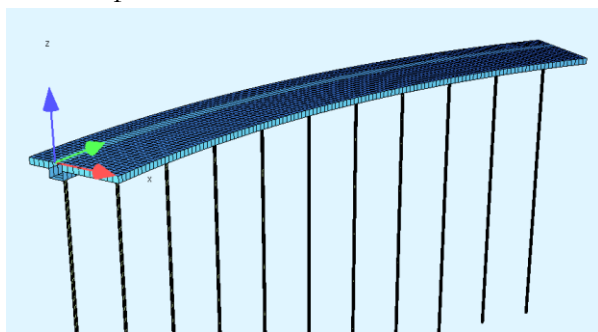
Modelo 3D estructura voladizo losa 1.0 m
